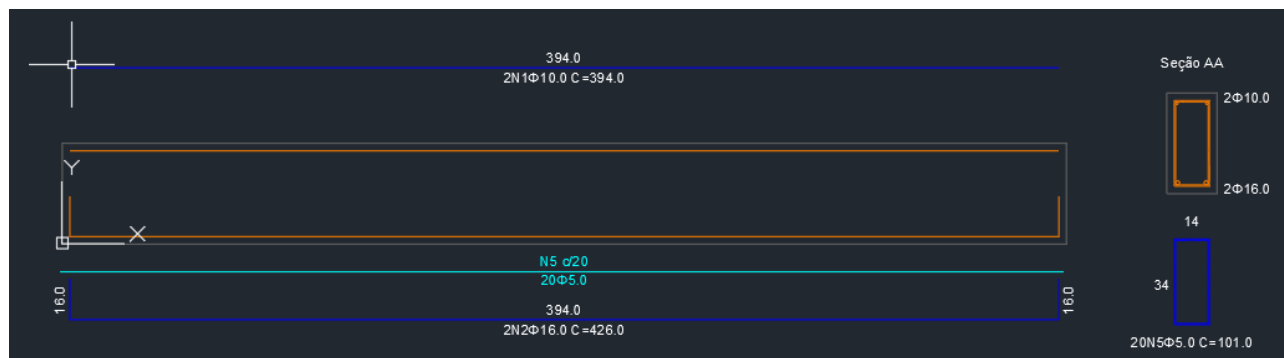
Detalhamento da viga proposta. (Fonte: Autoria própria, 2023).
